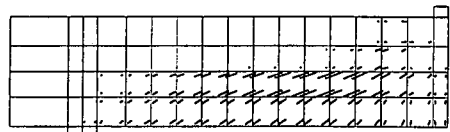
No.3のひび割れ状況(回転ひび割れモデル)
